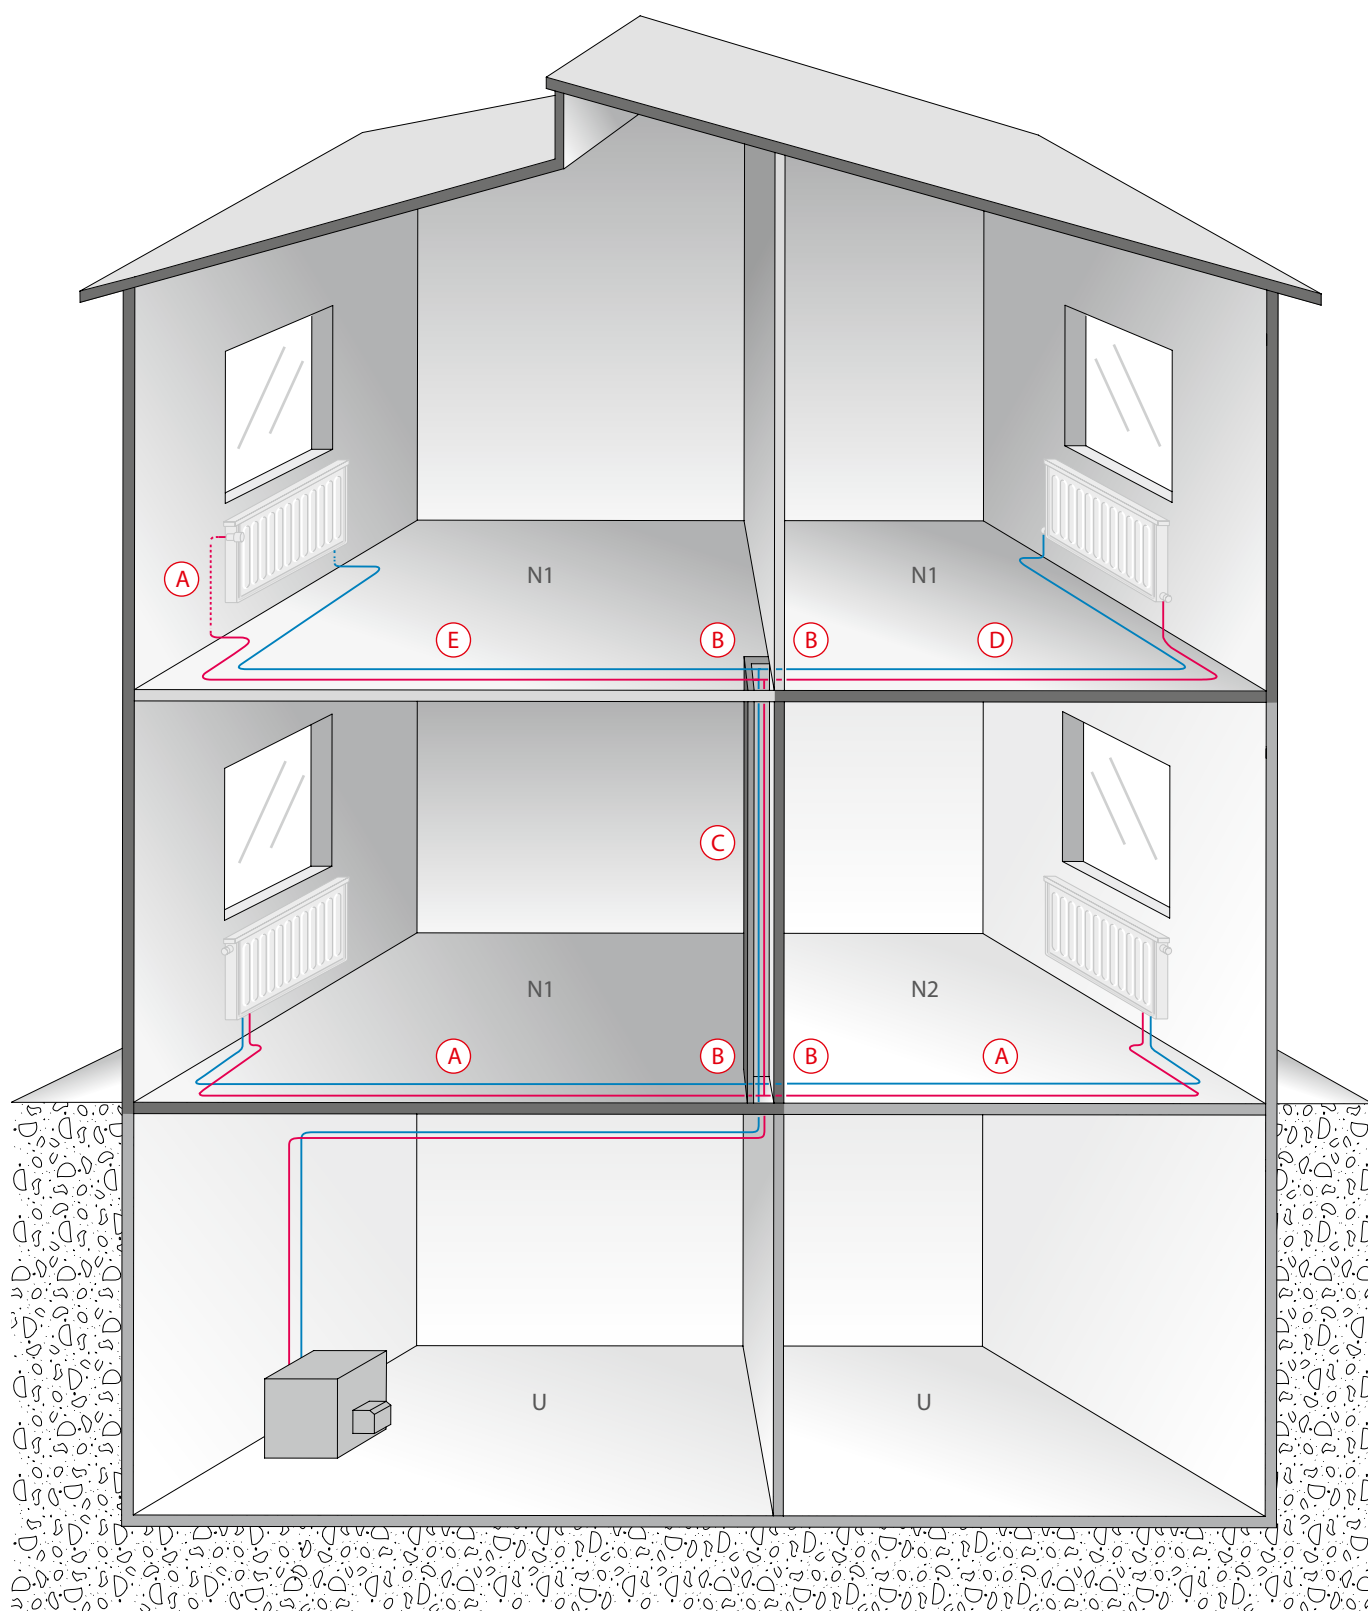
Монтажные ситуации теплоизоляции трубопроводов
